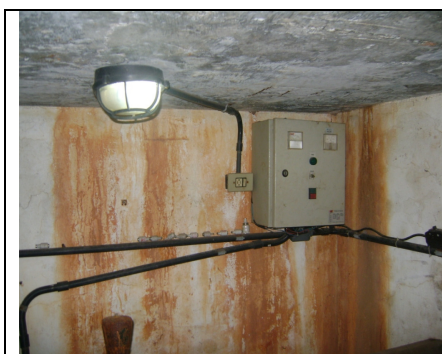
EERD-02: pintura interna da estação elevatória deteriorada.
